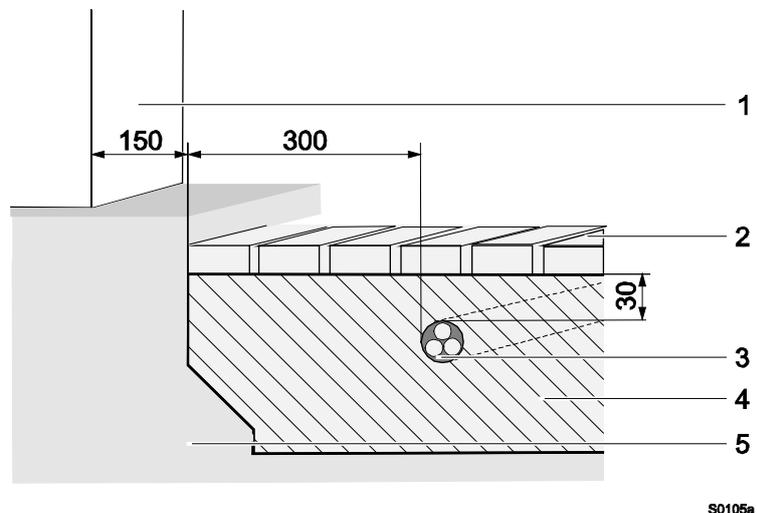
Induktionsschleife in Bitumen, Asphalt oder Beton verlegen (Maße in mm)
